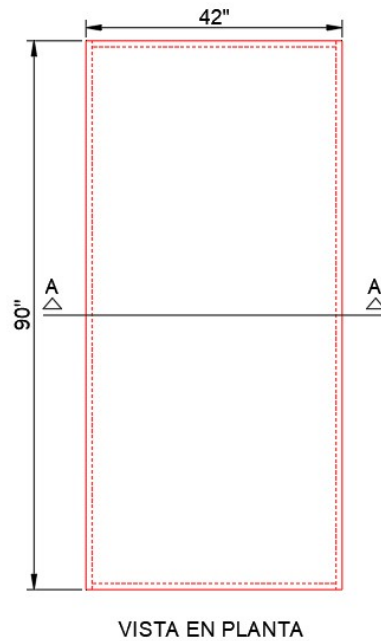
Dimensiones de panel de aluminio - Vista en planta
